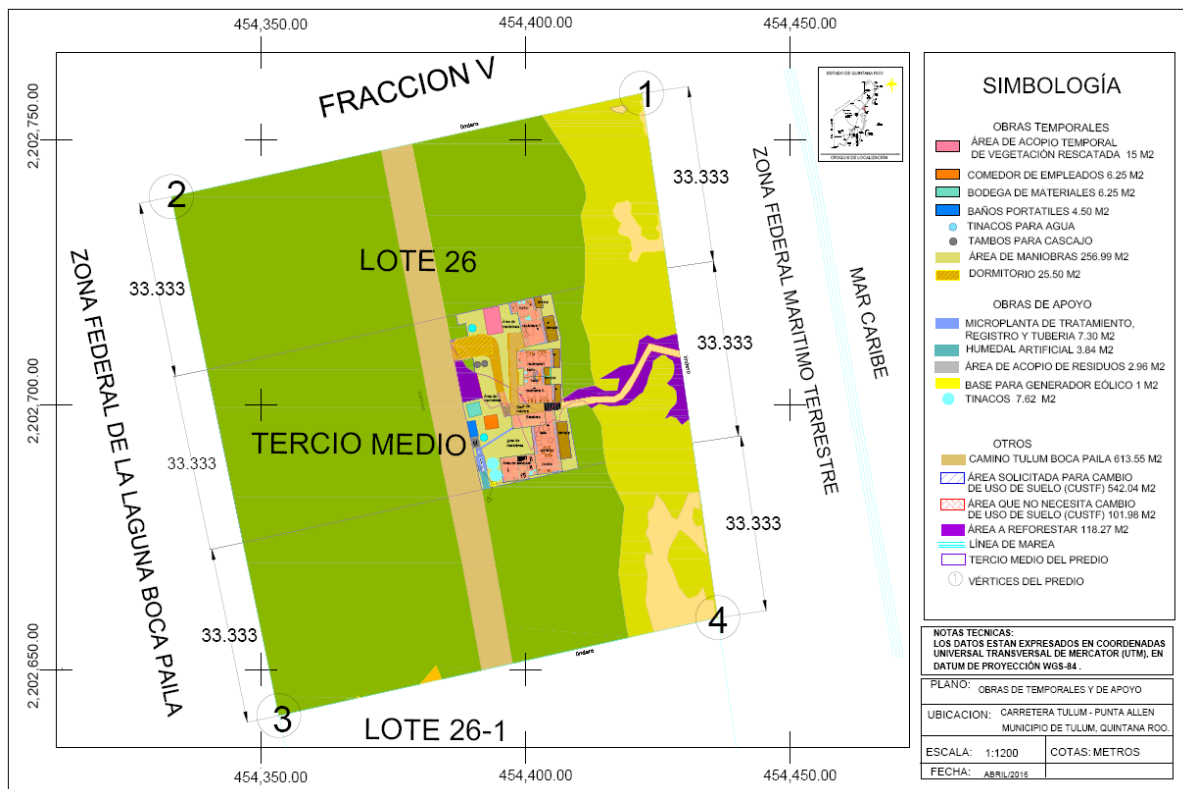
Plano de obras temporales (plano 10 de anexo planos).
